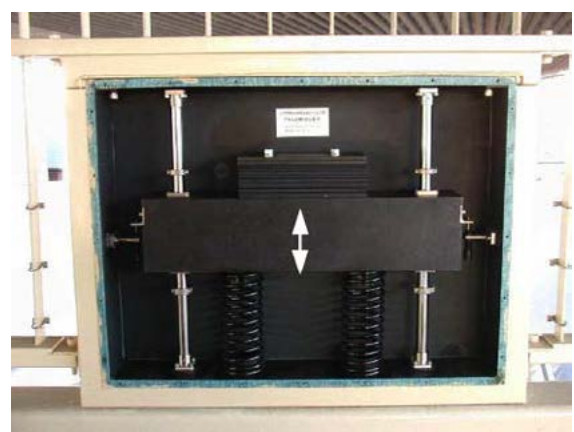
Schwingungstilger mit geringer Baubreite in einer Brücke in Japan
